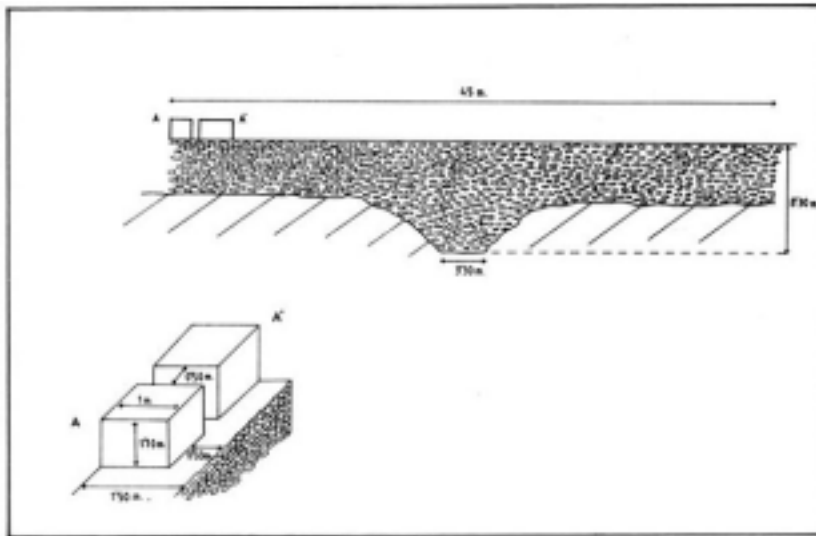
Presa de la Revuelta. Reconstrucción de su alzado. A-A', Detalle del aliviadero.
